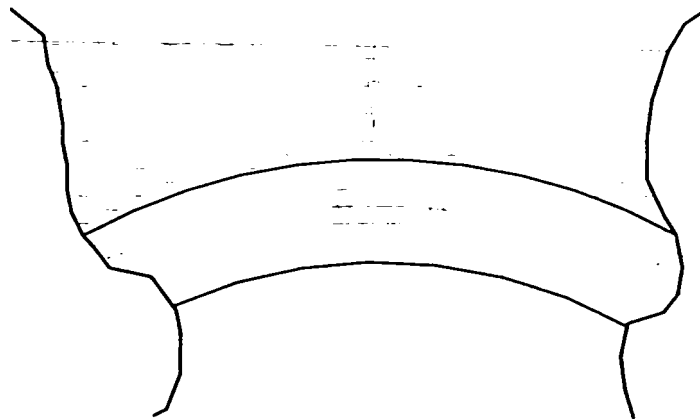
Determinarea deplasărilor orizontale prin metoda drumuirii planimetrice
